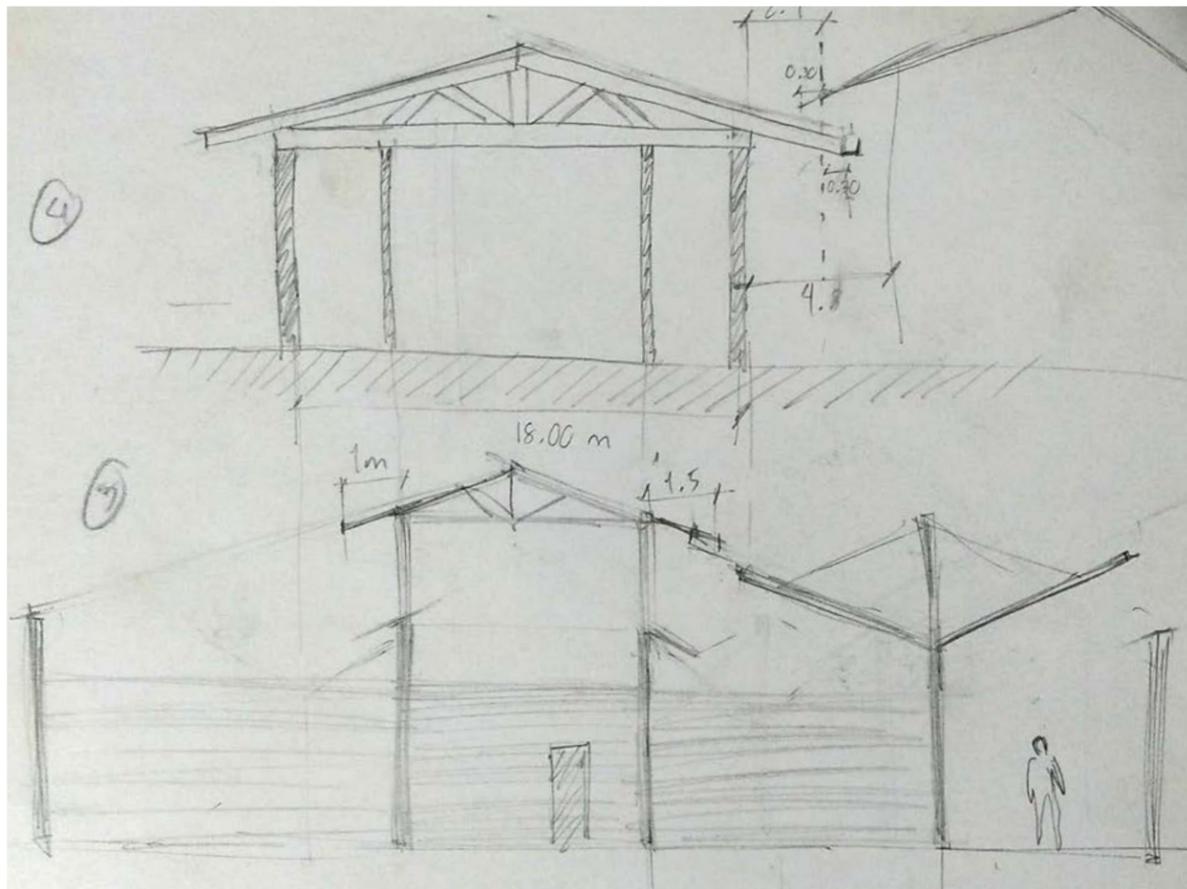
Croquis de estructura de cubierta. Elaboración propia.
